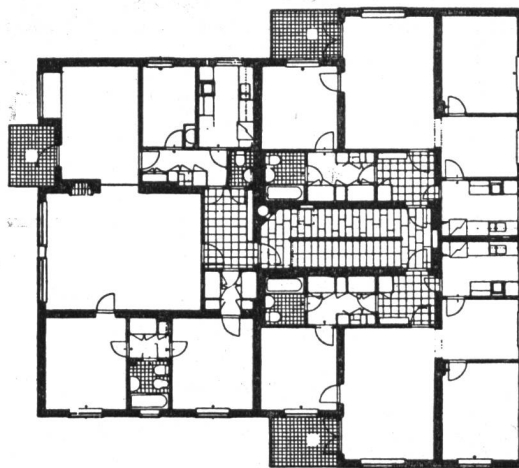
T-Haus-Grundriss der Siedlung auf Lidingö bei Stockholm. Zwei Vierzimmer- und eine Fünzimmerwohnung, an zentralem Treppenhaus, wo auch Badezimmer mit WC konzentriert sind. Arch. Ancker, Gate, Lindegren.
